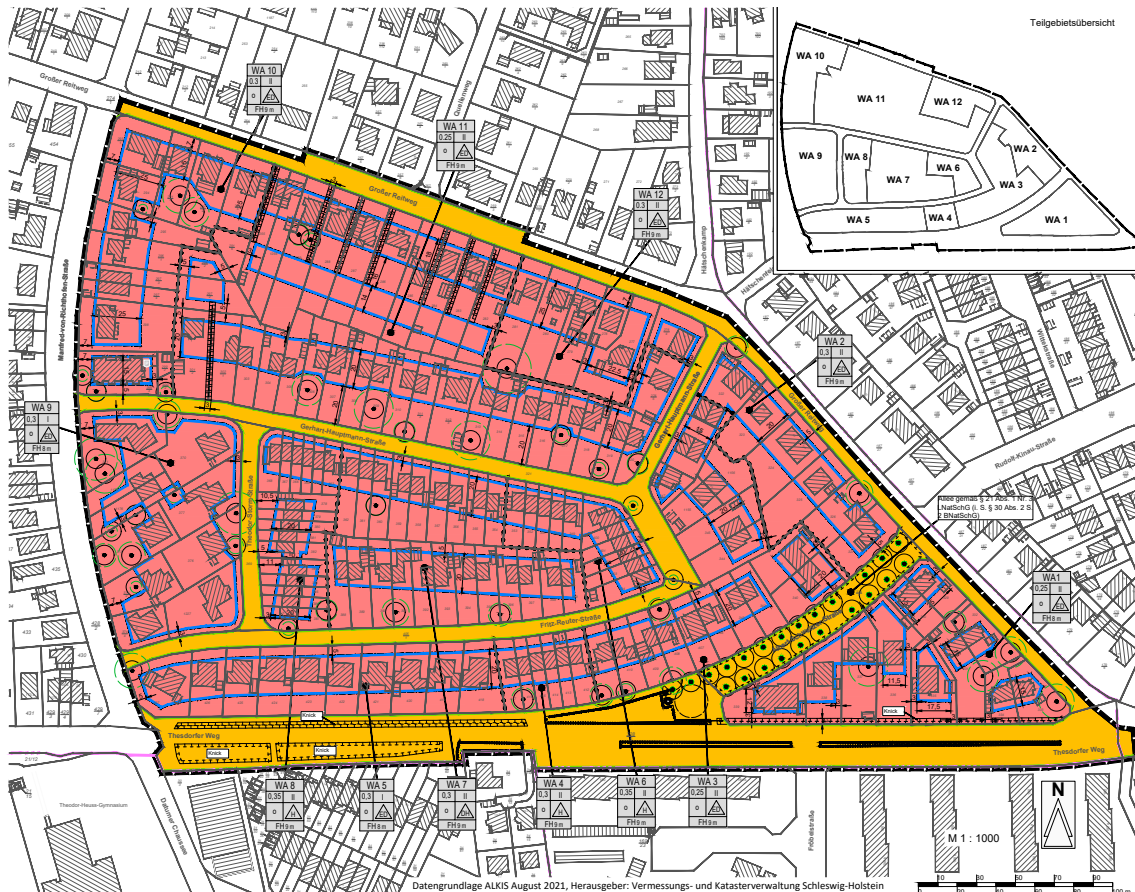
Planzeichnung BP Nr. 161 (Verfahrensstand: Entwurf)
